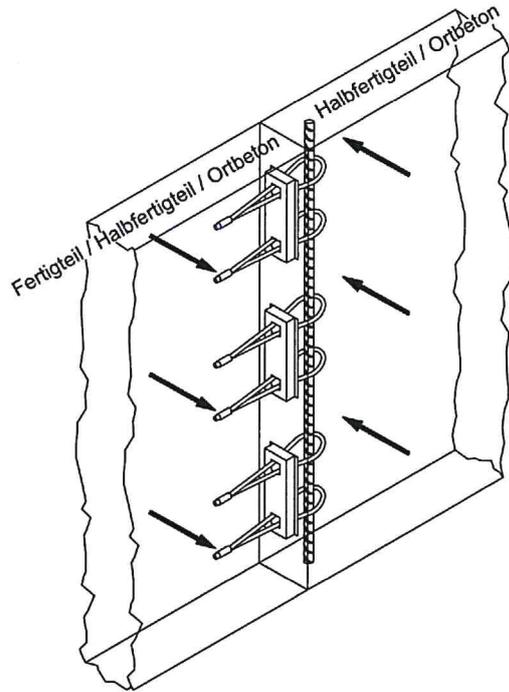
Beanspruchung senkrecht zur Fugenlängsrichtung und Wandebene
